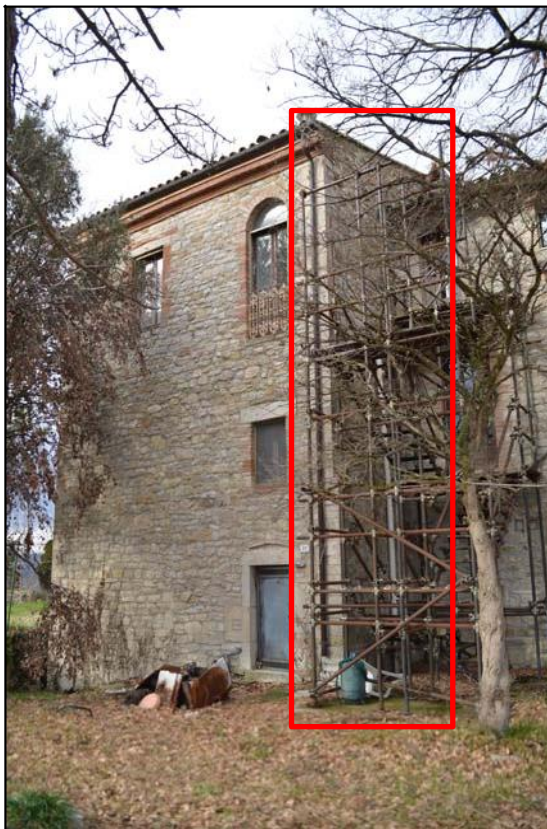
Parete dell'ala sud interessata dalla lesione
